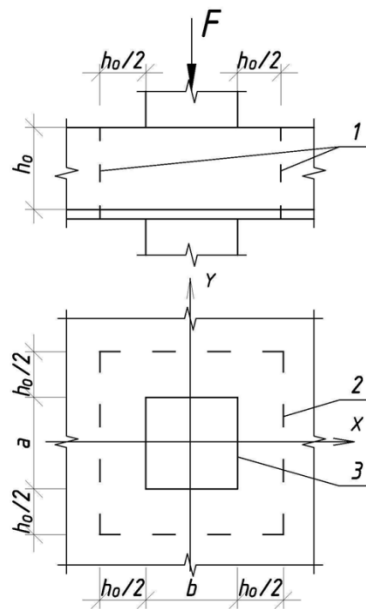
Схема для расчета железобетонных элементов без поперечной арматуры на продавливание
